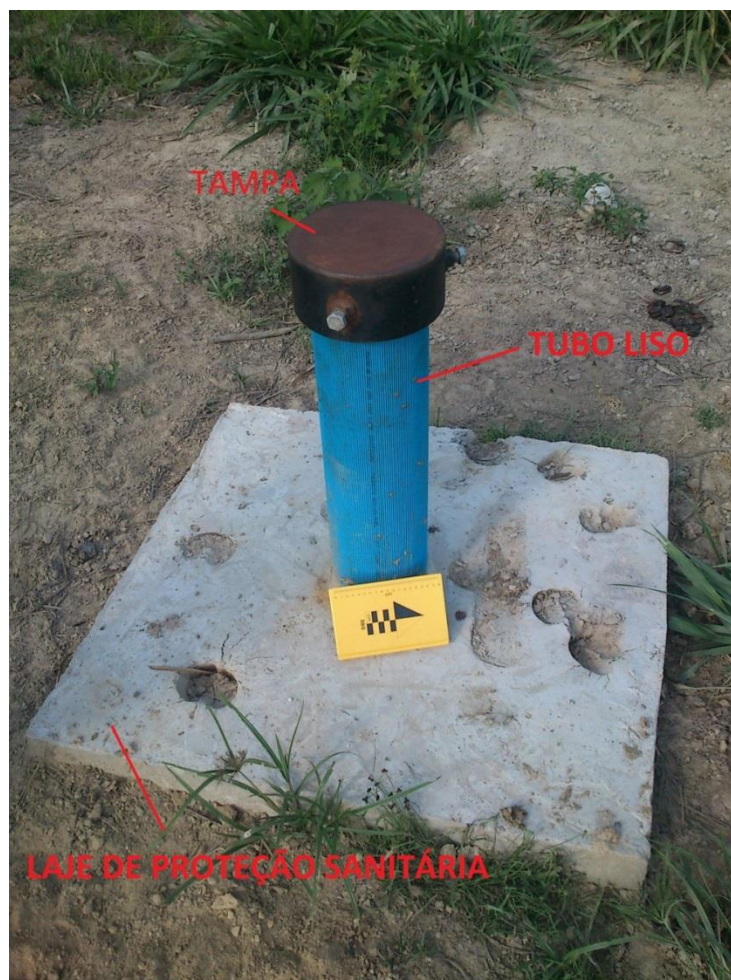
Poço tubular com tampa, tubo liso de PVC e a laje de proteção sanitária. Fonte: Autora.
